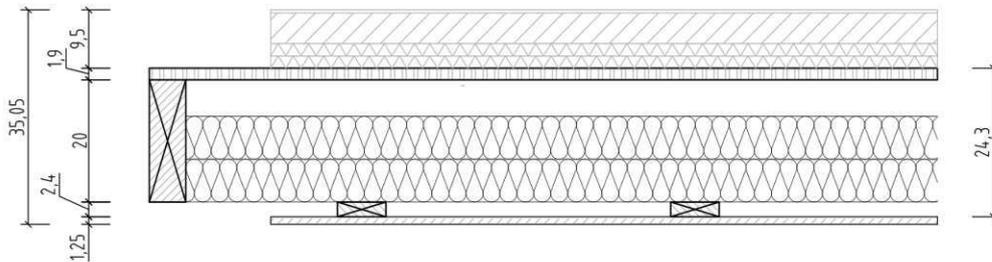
Geschoßdecke Haus C (Quelle: eigene Darstellung)
